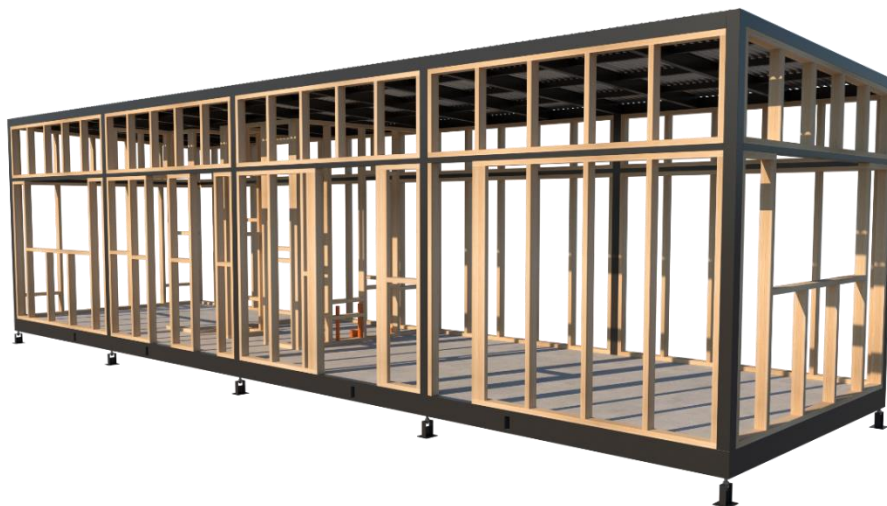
Módulo con el panelizado en Wood Frame completo. Fuente: Elaboración propia.
